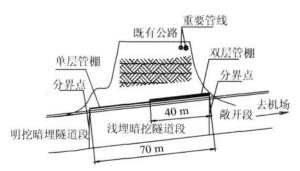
下穿嘉和路左线隧道管棚支护剖面图 Fig. 1 The left line tunnel under the Jiahe Road pipe roof
